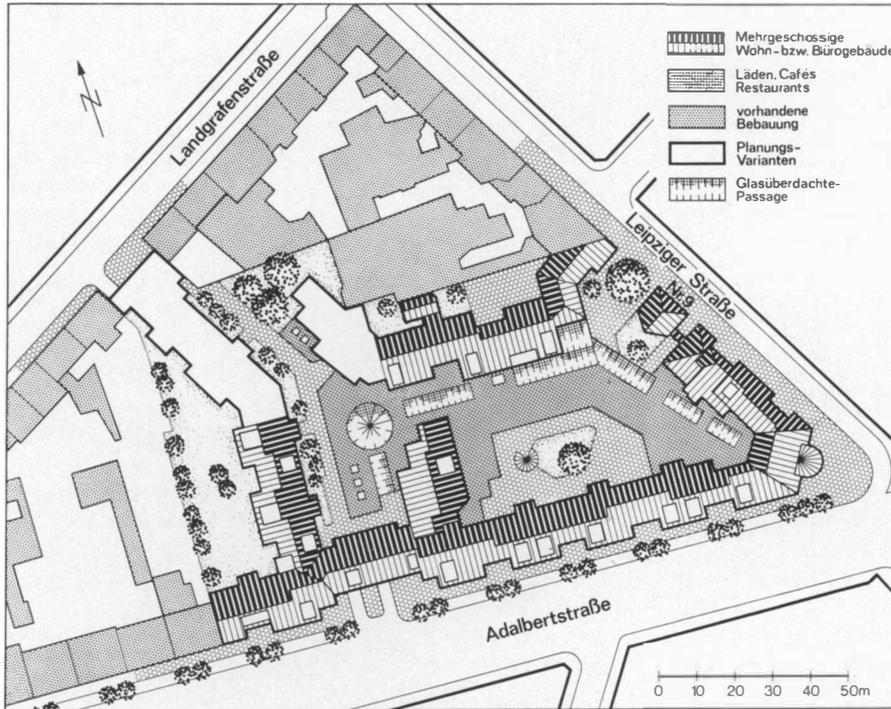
Lageplan für die Neubebauung in einem Teilraum des Sanierungsgebietes Ost
